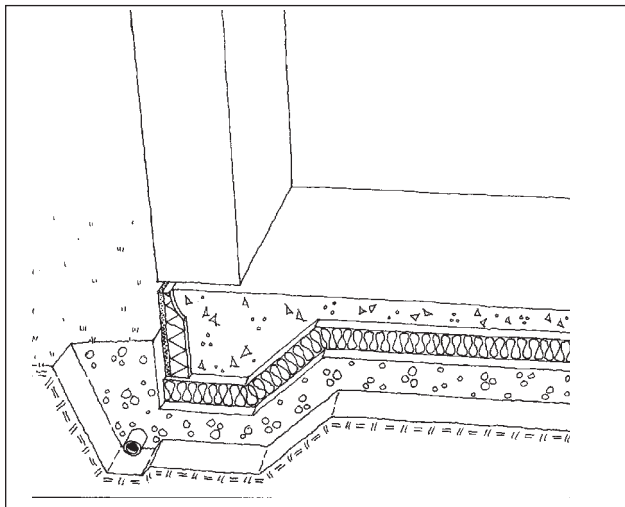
Теплоизоляция всегда устанавливается на всей площади плиты. Минимальная толщина дренажирующего материала под теплоизоляцией составляет 100 мм. Края изолируются, если толщина теплоизоляции плиты более 120 мм.
